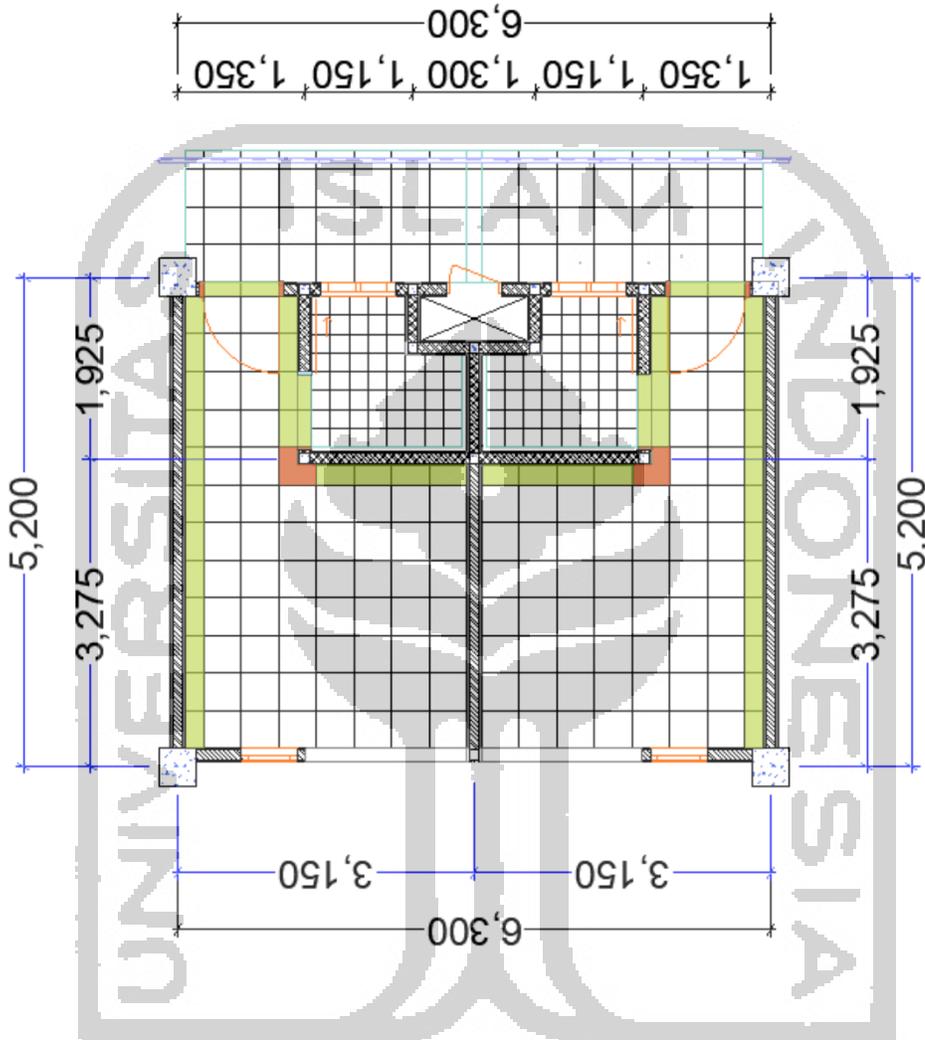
Analisa Ruang Kamar terpilih pada proyek co-working space dengan boarding house eksklusif modul keramik 30×30
